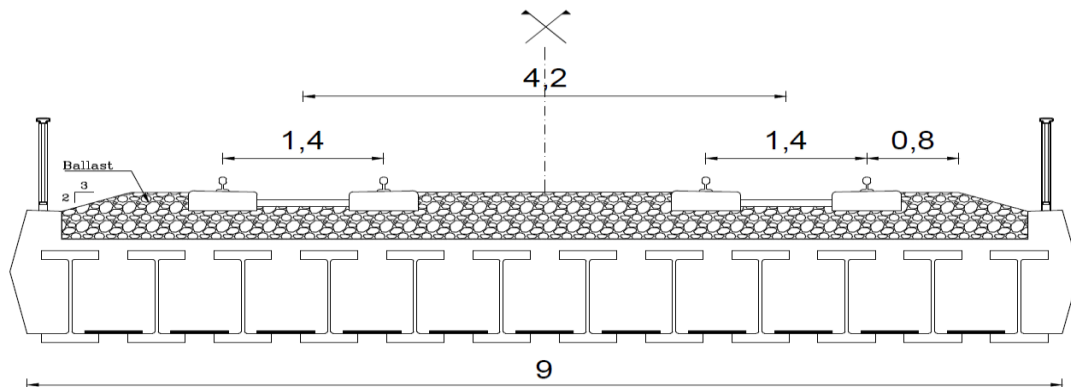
Exemple d'un pont de type poutrelles enrobées.
